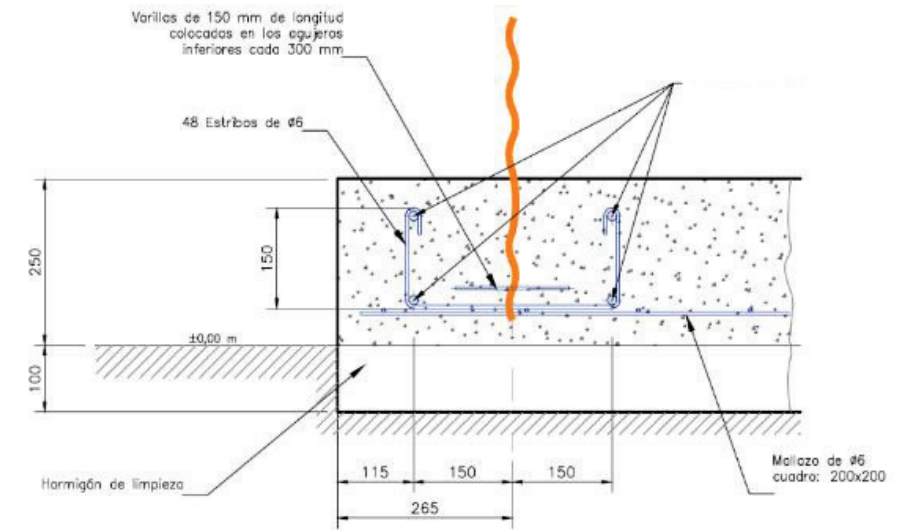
Detalle de conexión chapa minionda con losa de hormigón – Extracto de los planos de Proyecto (Hoja N° 3)
